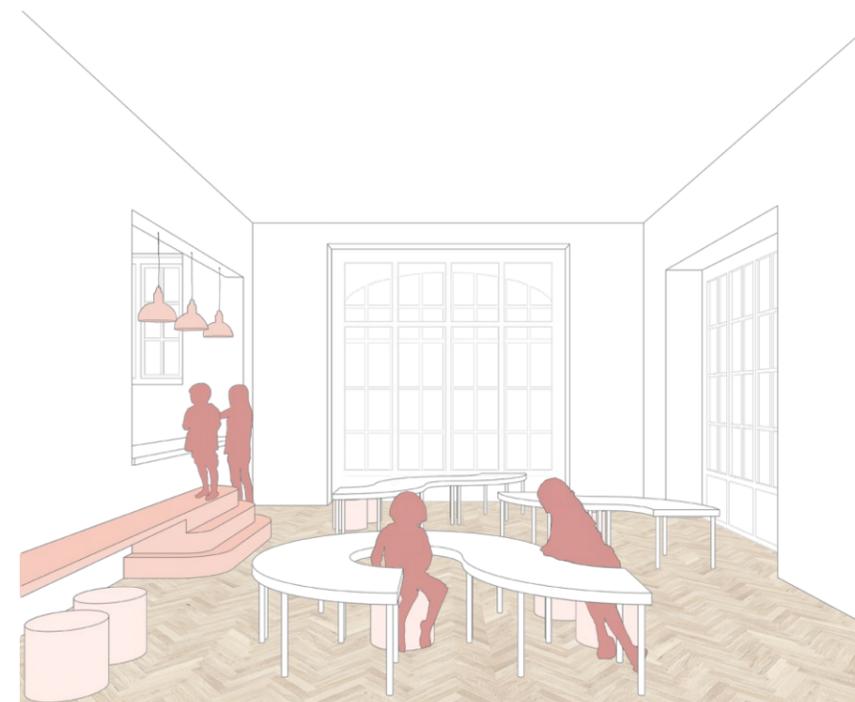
Darstellung Speiseraum, Raum 10, Erdgeschoss.
